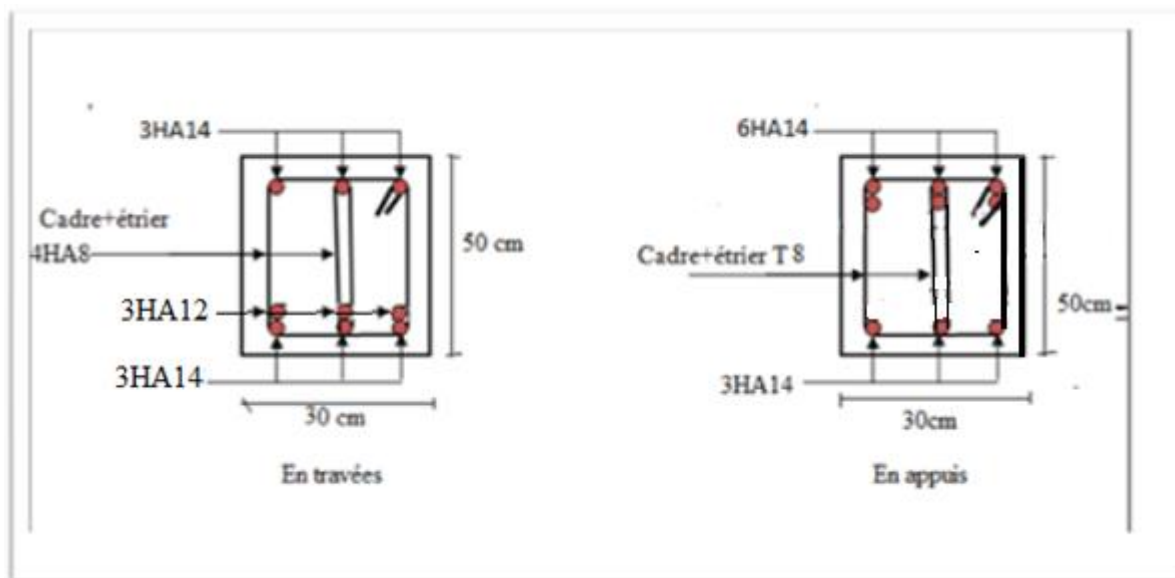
schéma de ferrailage poutres principales étage09 et 10
